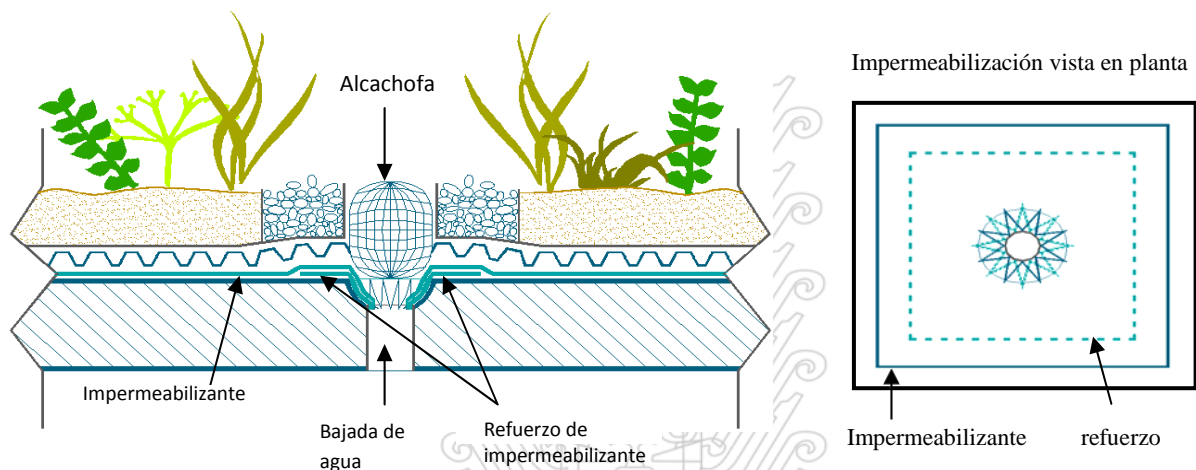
Impermeabilización y refuerzo en puntos de encuentro con bajadas de agua.
